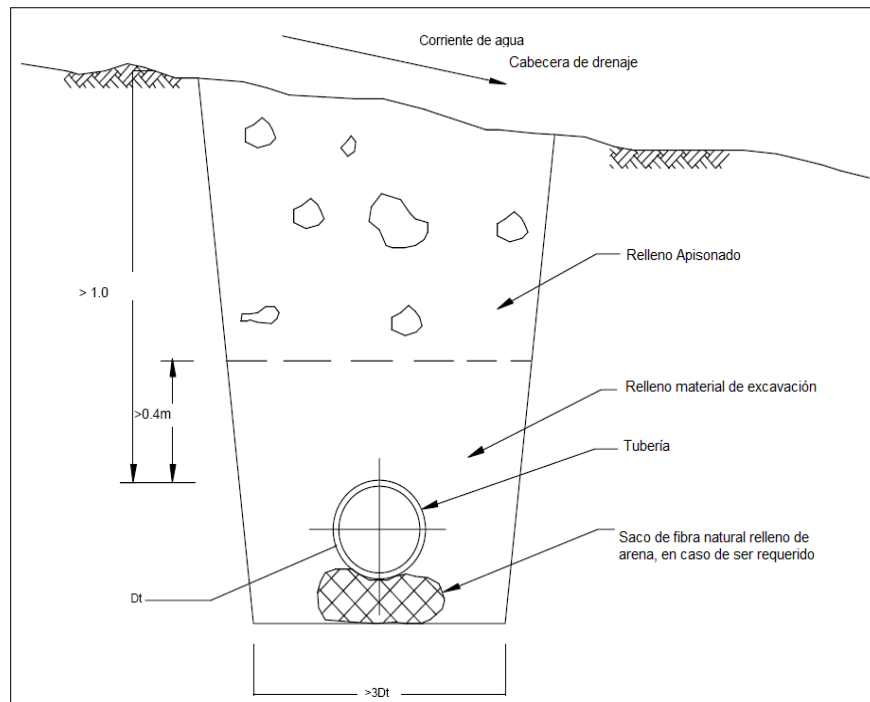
Esquema tipo de cruce subfluvial, en zanja, bajado y tapado. Cruce con cabeceras de drenaje
